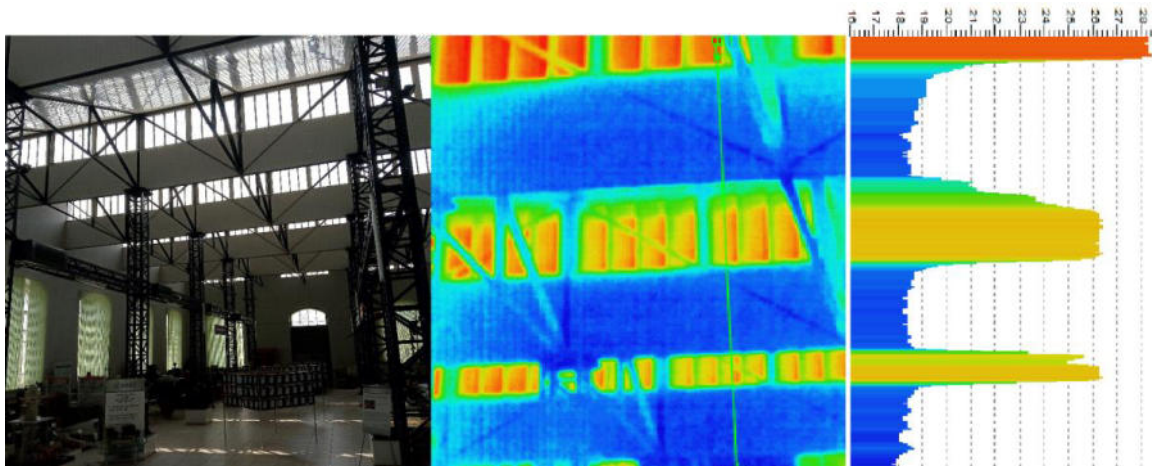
Фото та тепловізійний знімок даху будівлі
